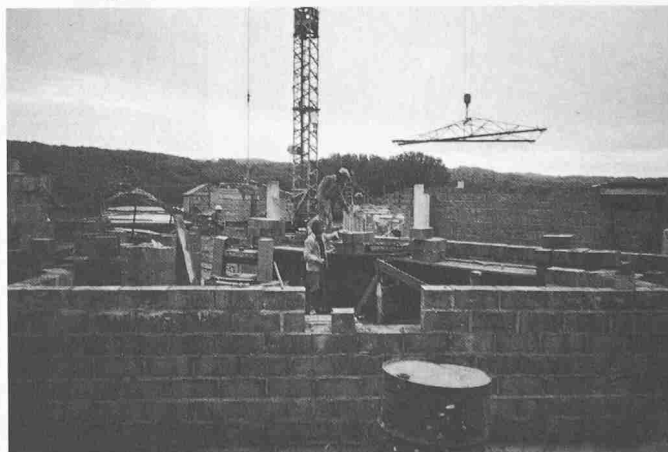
Slum-Upgrading (Foto Dr. G. L. Zander)
